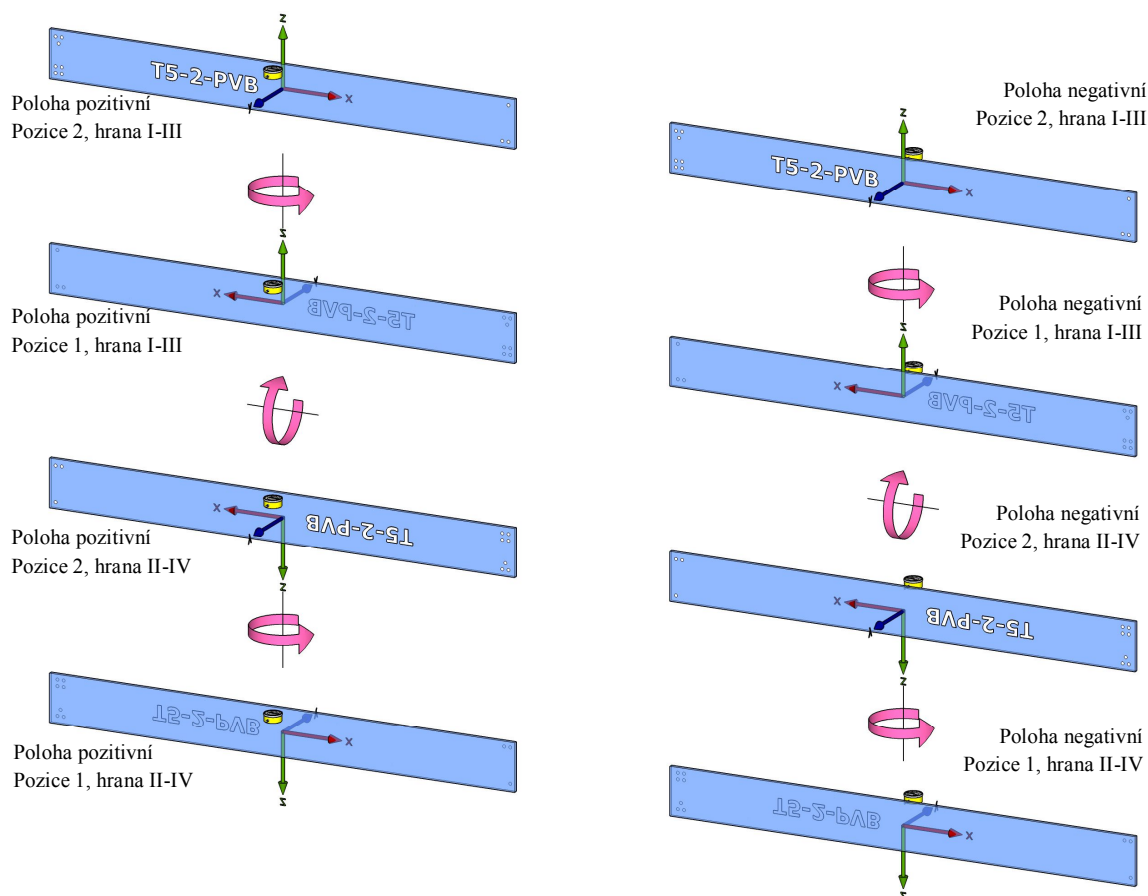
Měření geometrických imperfekcí – vlastní konstrukce autora
